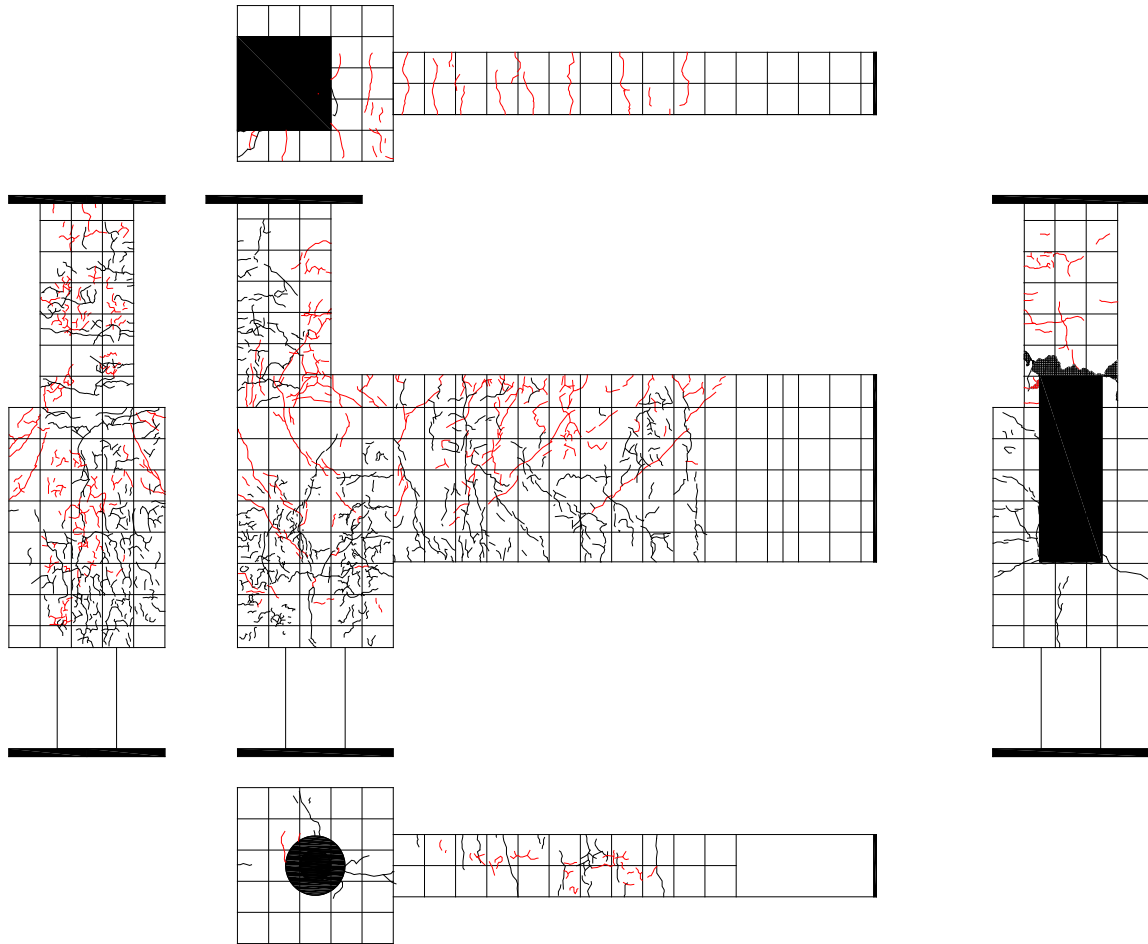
試験体 C-3 ひび割れ状況 (50cycle)
